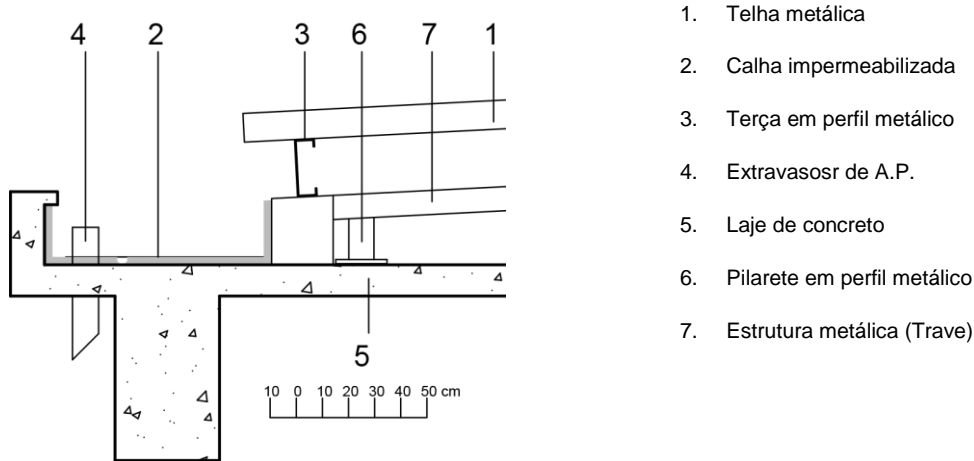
Detalhe da calha impermeabilizada (Fonte: SEF)
